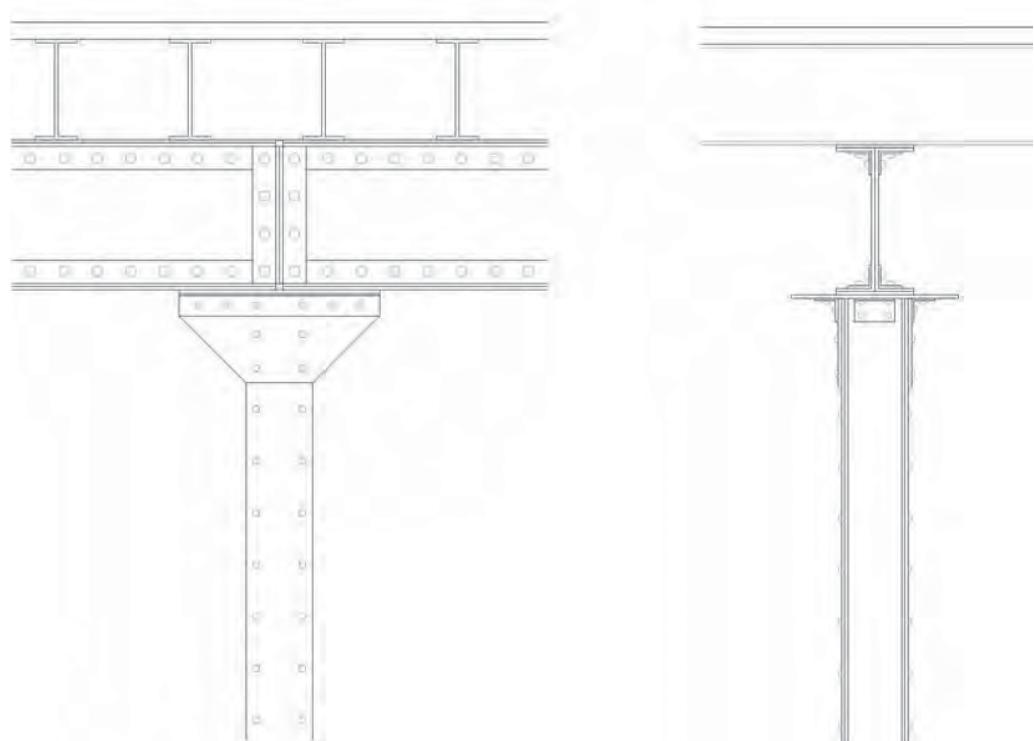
Detalle de estructura de pilares metálicos roblonada con capitel trapezoidal remachado.
